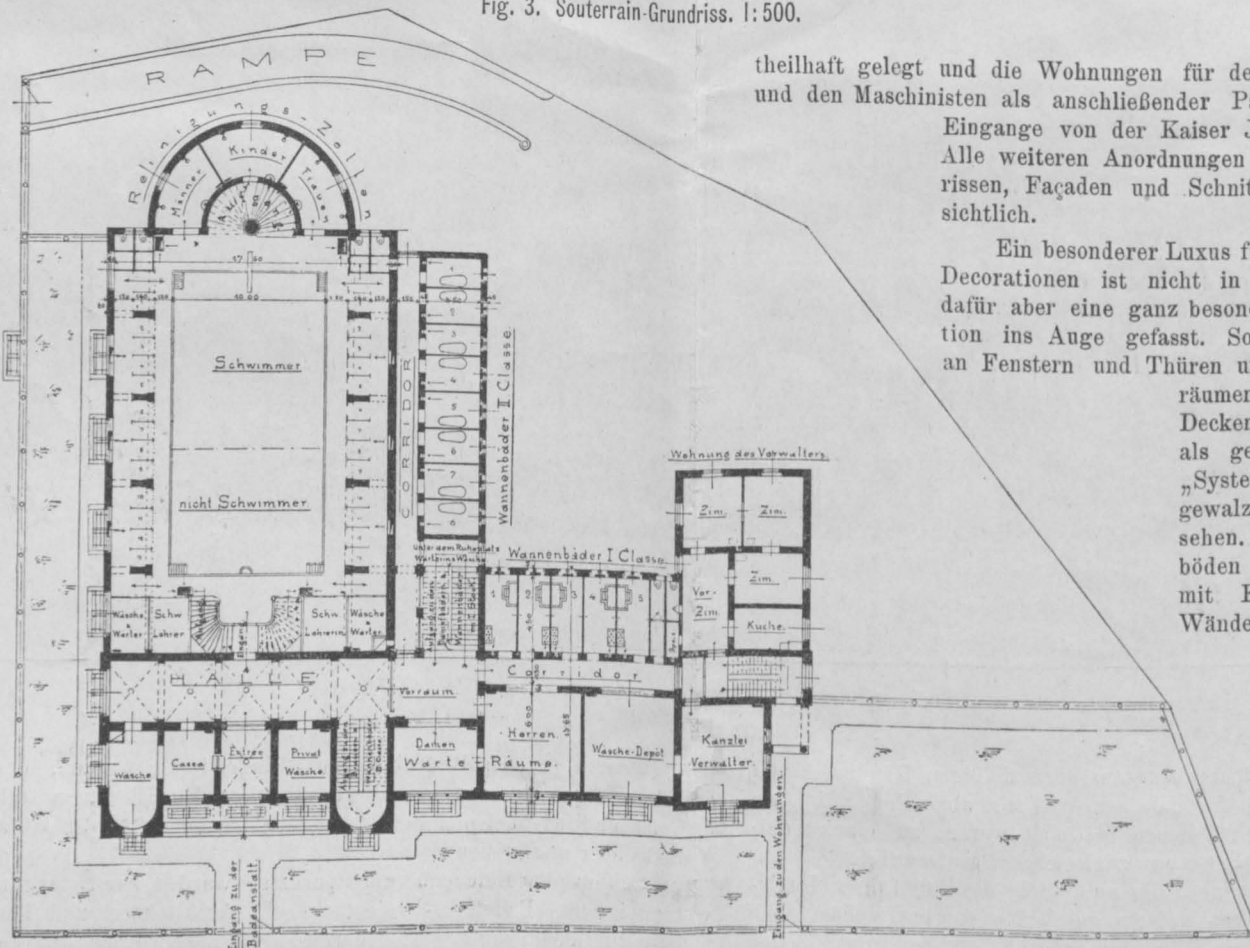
Ebenerd-Grundriss. 1:500.
